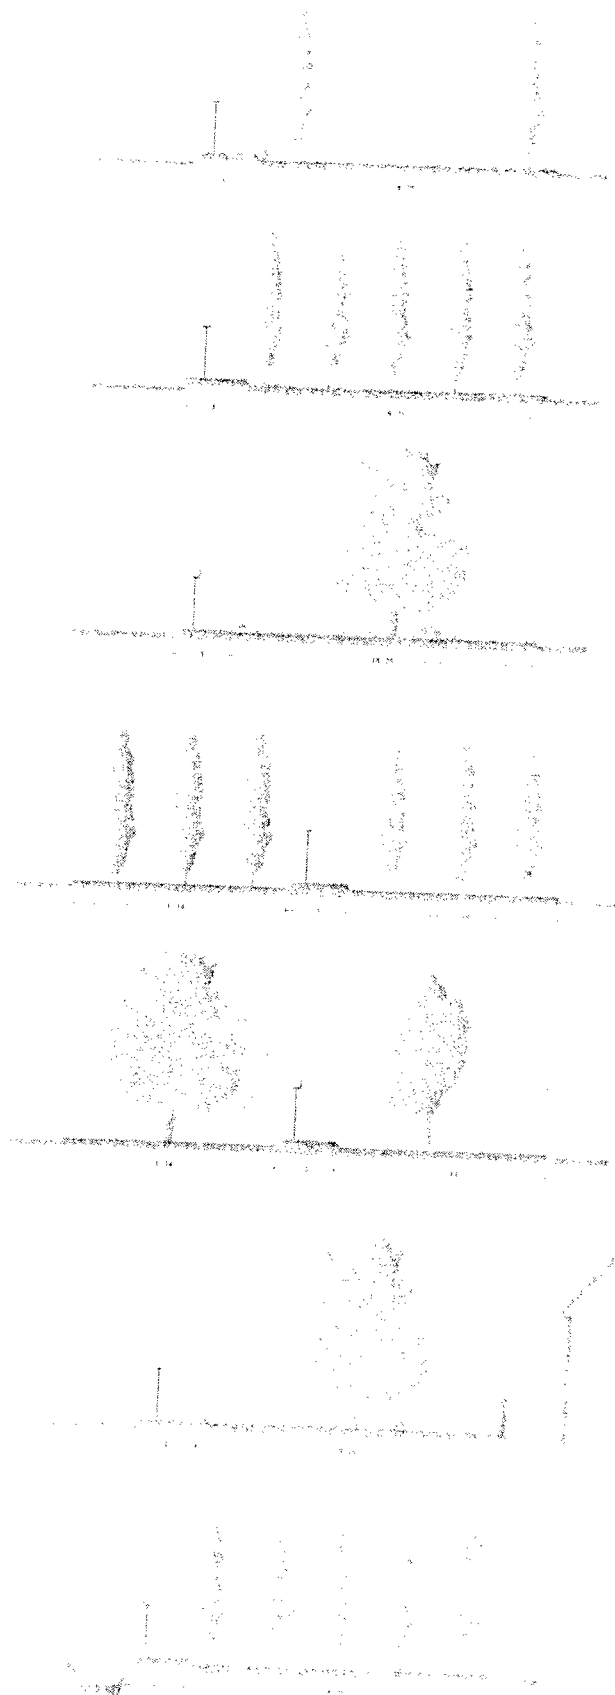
Abaco delle sezioni tipo di riferimento per la progettazione e realizzazione delle Aree di compensazione ambientale prioritarie
